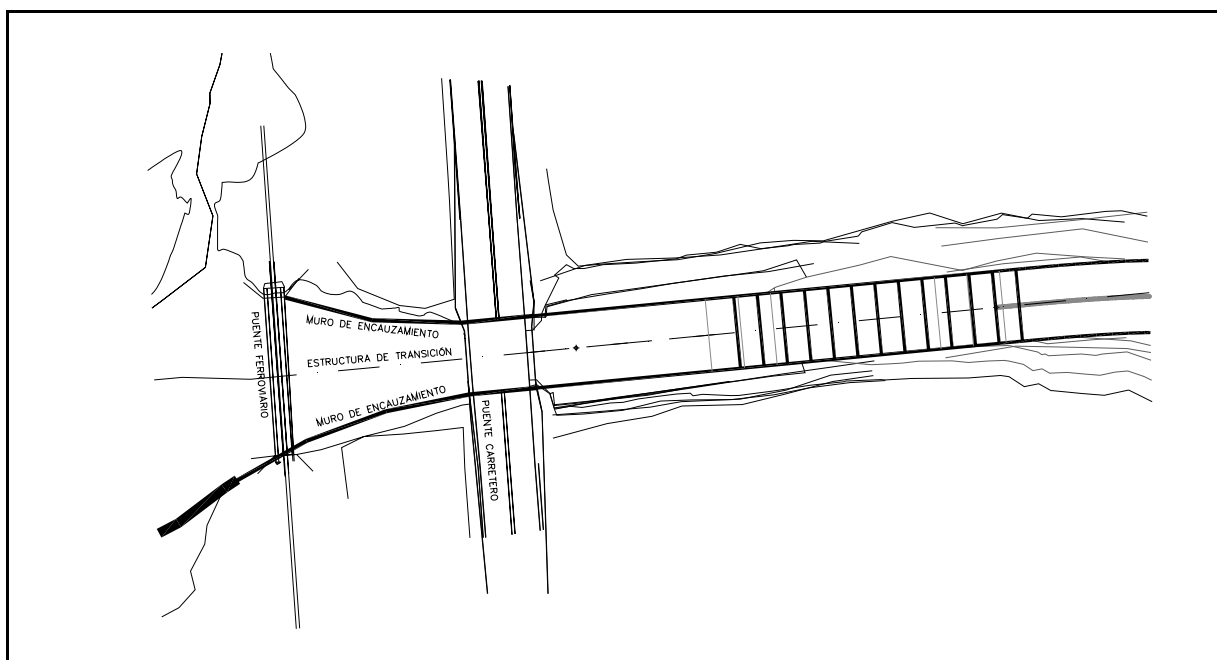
Plano en planta de la implementación de la rugosidad en la rapida.
